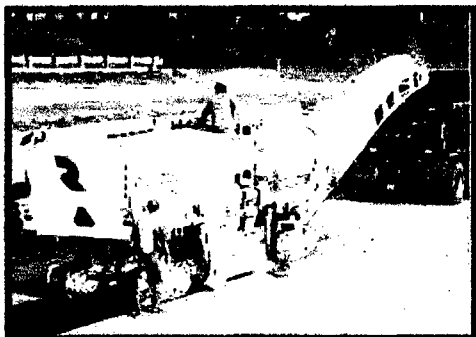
Máquina fresadora, equipo que fresa en frío.
